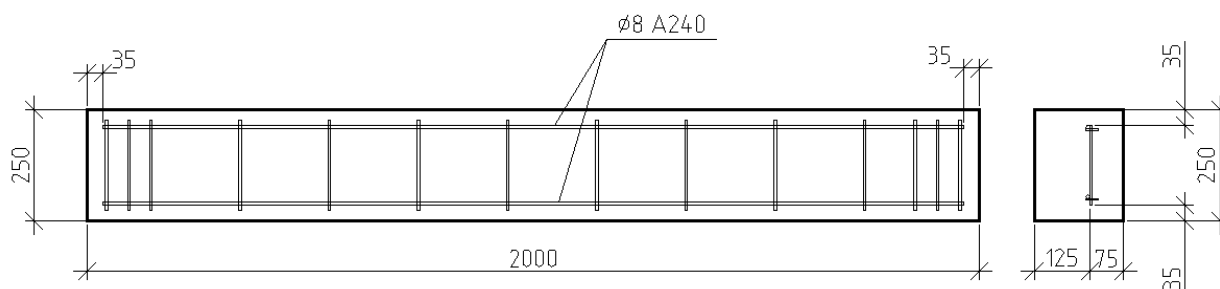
Схема армирования перемычки с плоским каркасом
